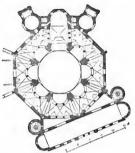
S. Vitale in Ravenna. Grundriss.
